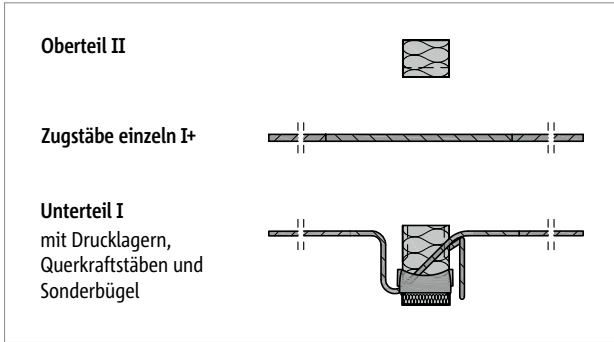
Schöck Isokorb® RT Typ K: Produktschnitt
